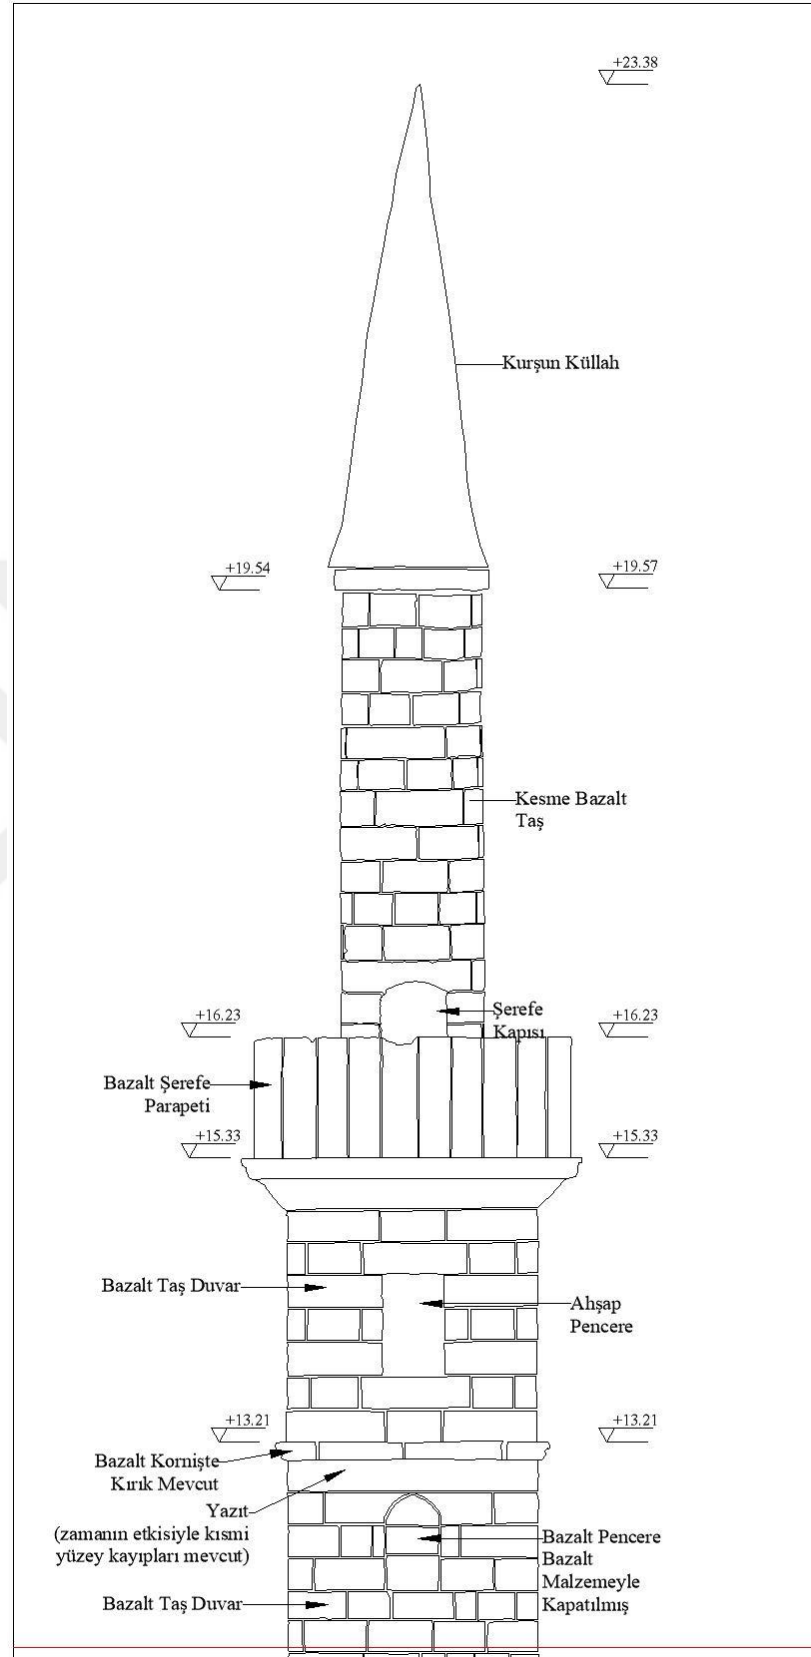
Batı cephesinin detaylı çizimi-2.
